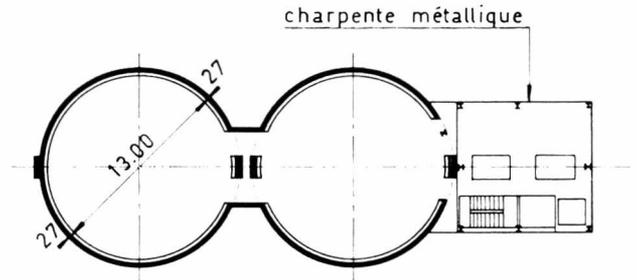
Coupe horizontale, au niveau du local de distribution d'air comprimé
